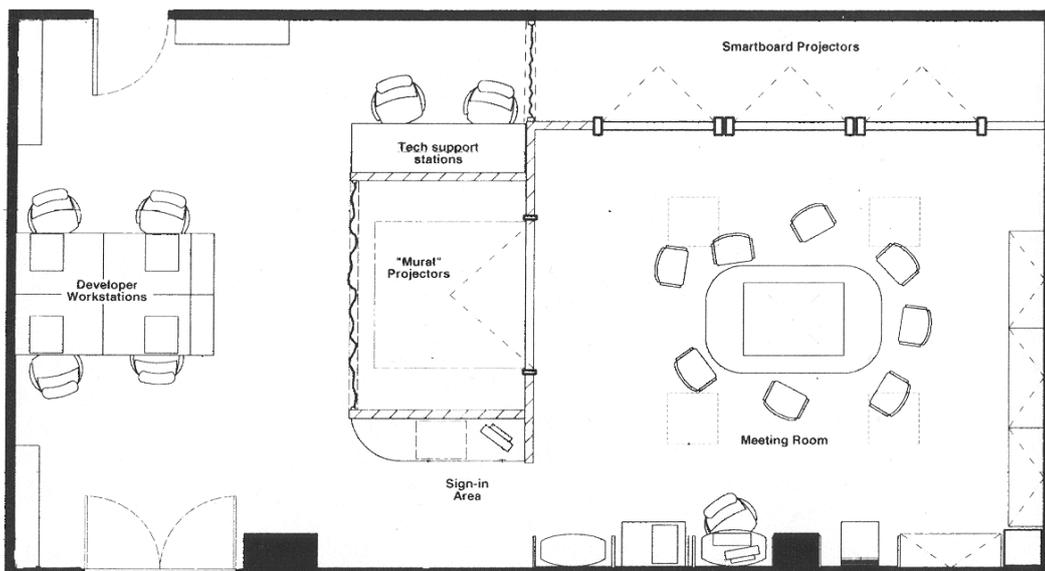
Grundriss des *iRoom
